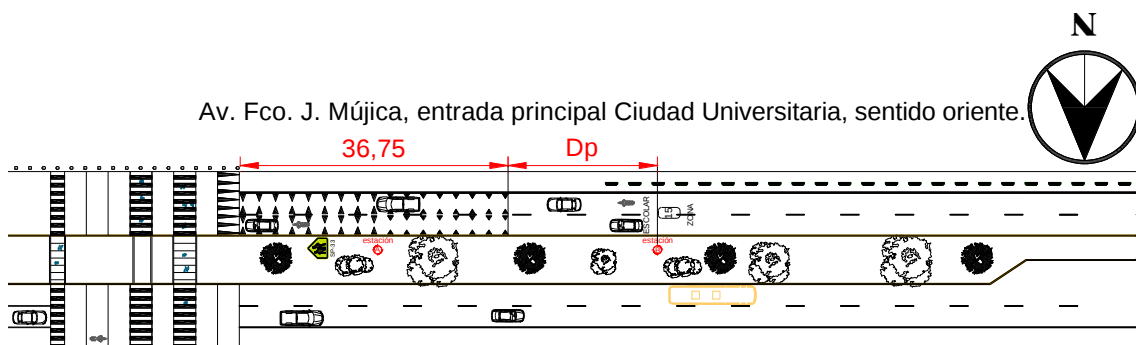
Planta geométrica de la zona escolar 01. Elaboración propia
